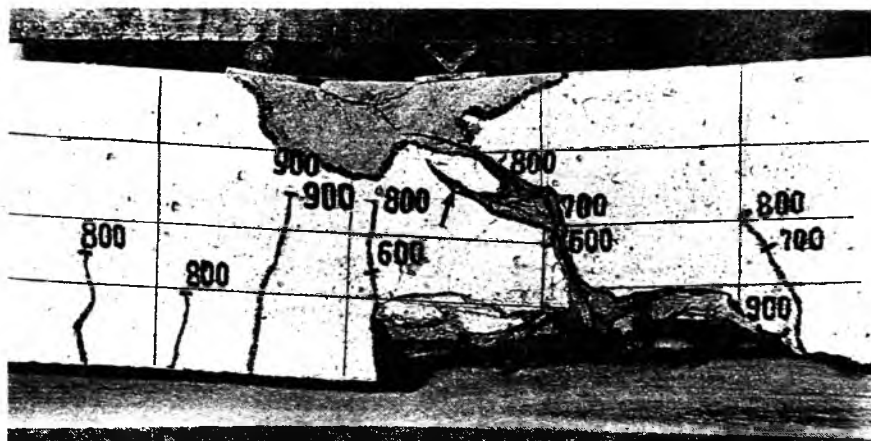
Разрушение по наклонному сечению балки из песчаного бетона с поперечной арматурой
